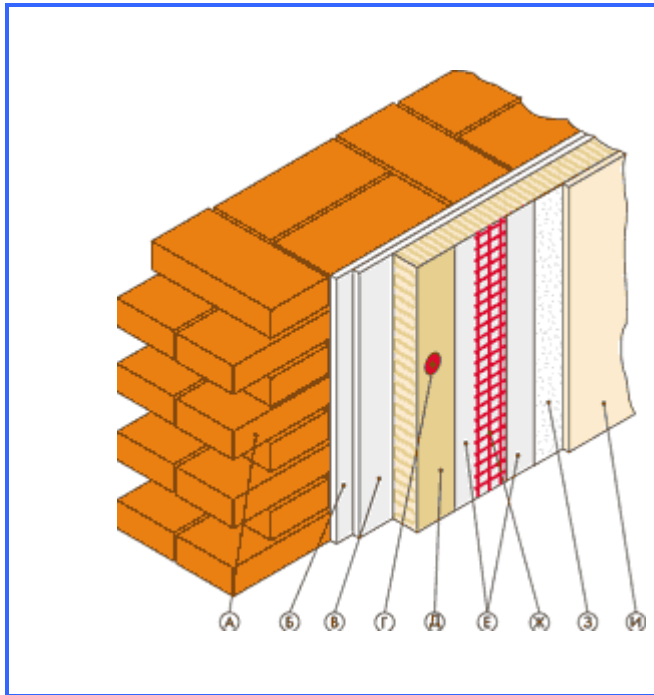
Утеплення фасадів штукатурним способом:
